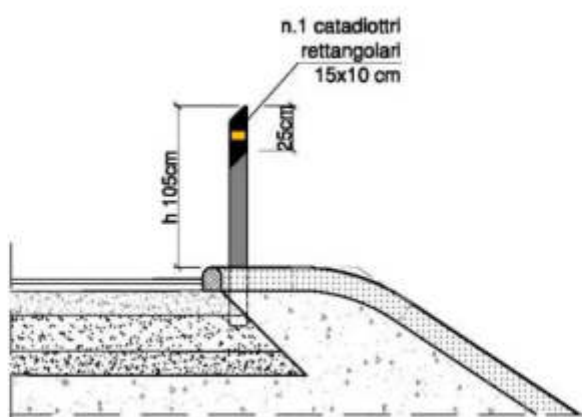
lato destro, in rilevato in assenza di barriere di sicurezza
